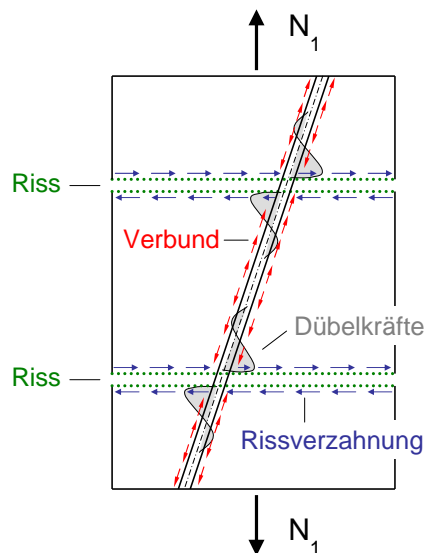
Maßgebliche Mechanismen der Risskraftübertragung bei schiefwinkliger Bewehrung
